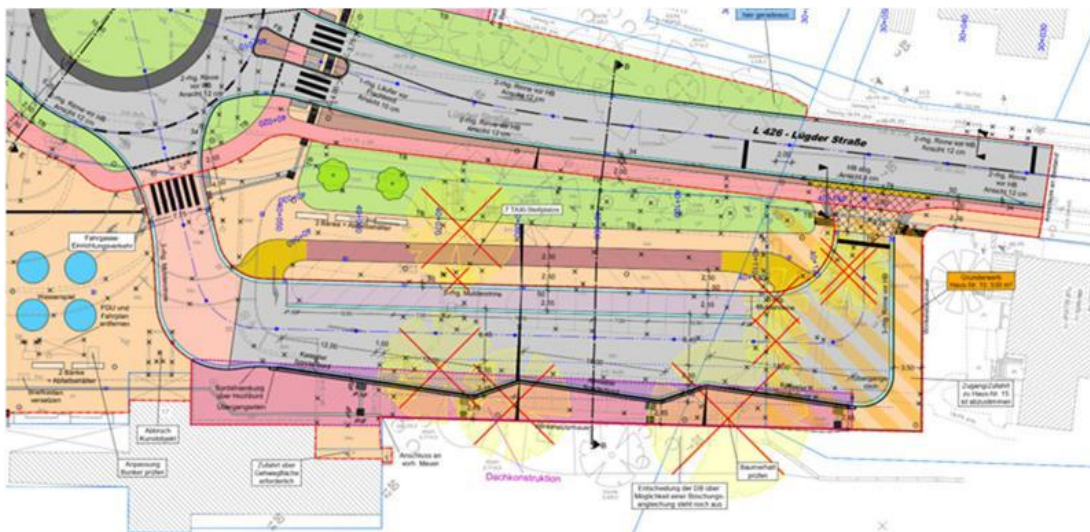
Lageplan Bereich Busbahnhof/Taxi-Stellplätze
